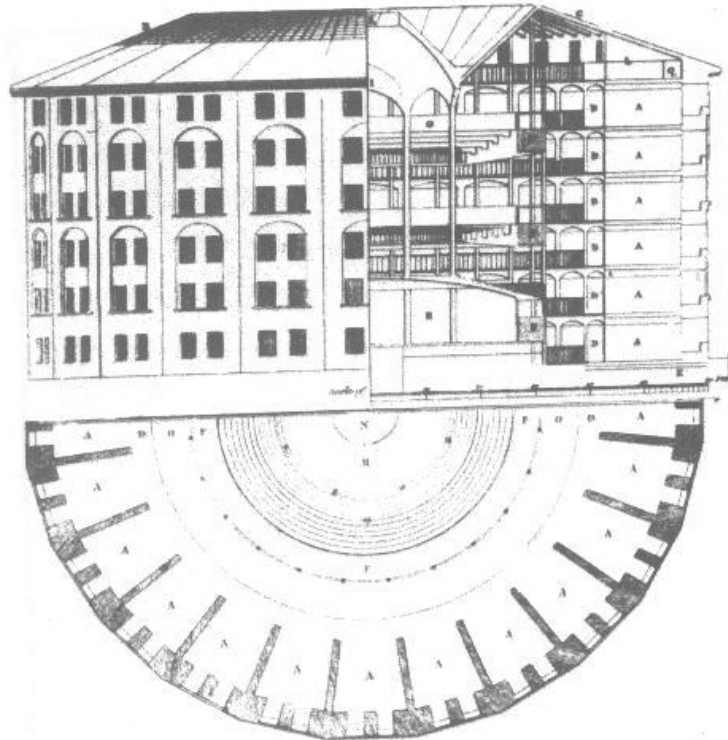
Planta e corte do *Panóptico* de Bentham. (Fonte: MARIN, André Pierre. 2000)
